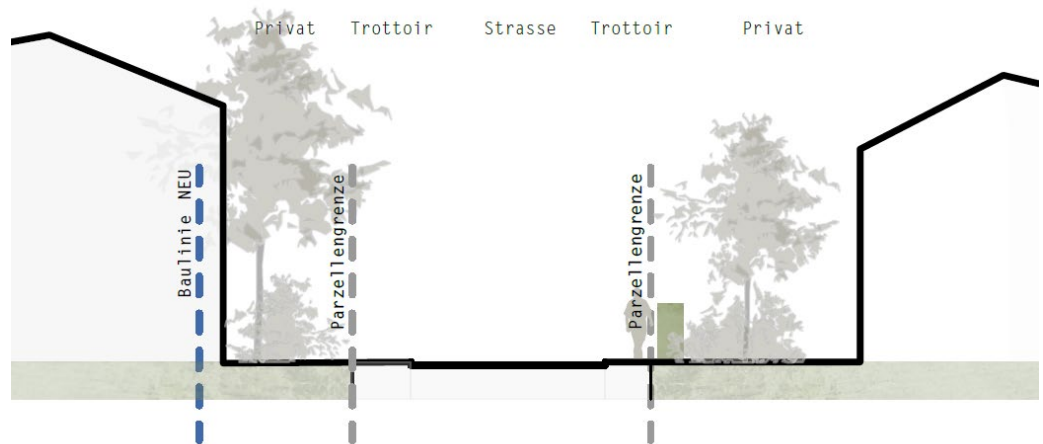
Prinzipschnitt Lilienstrasse mit möglichen Baumpflanzungen auf privatem Grund (Westpol Landschaftsarchitekten)
